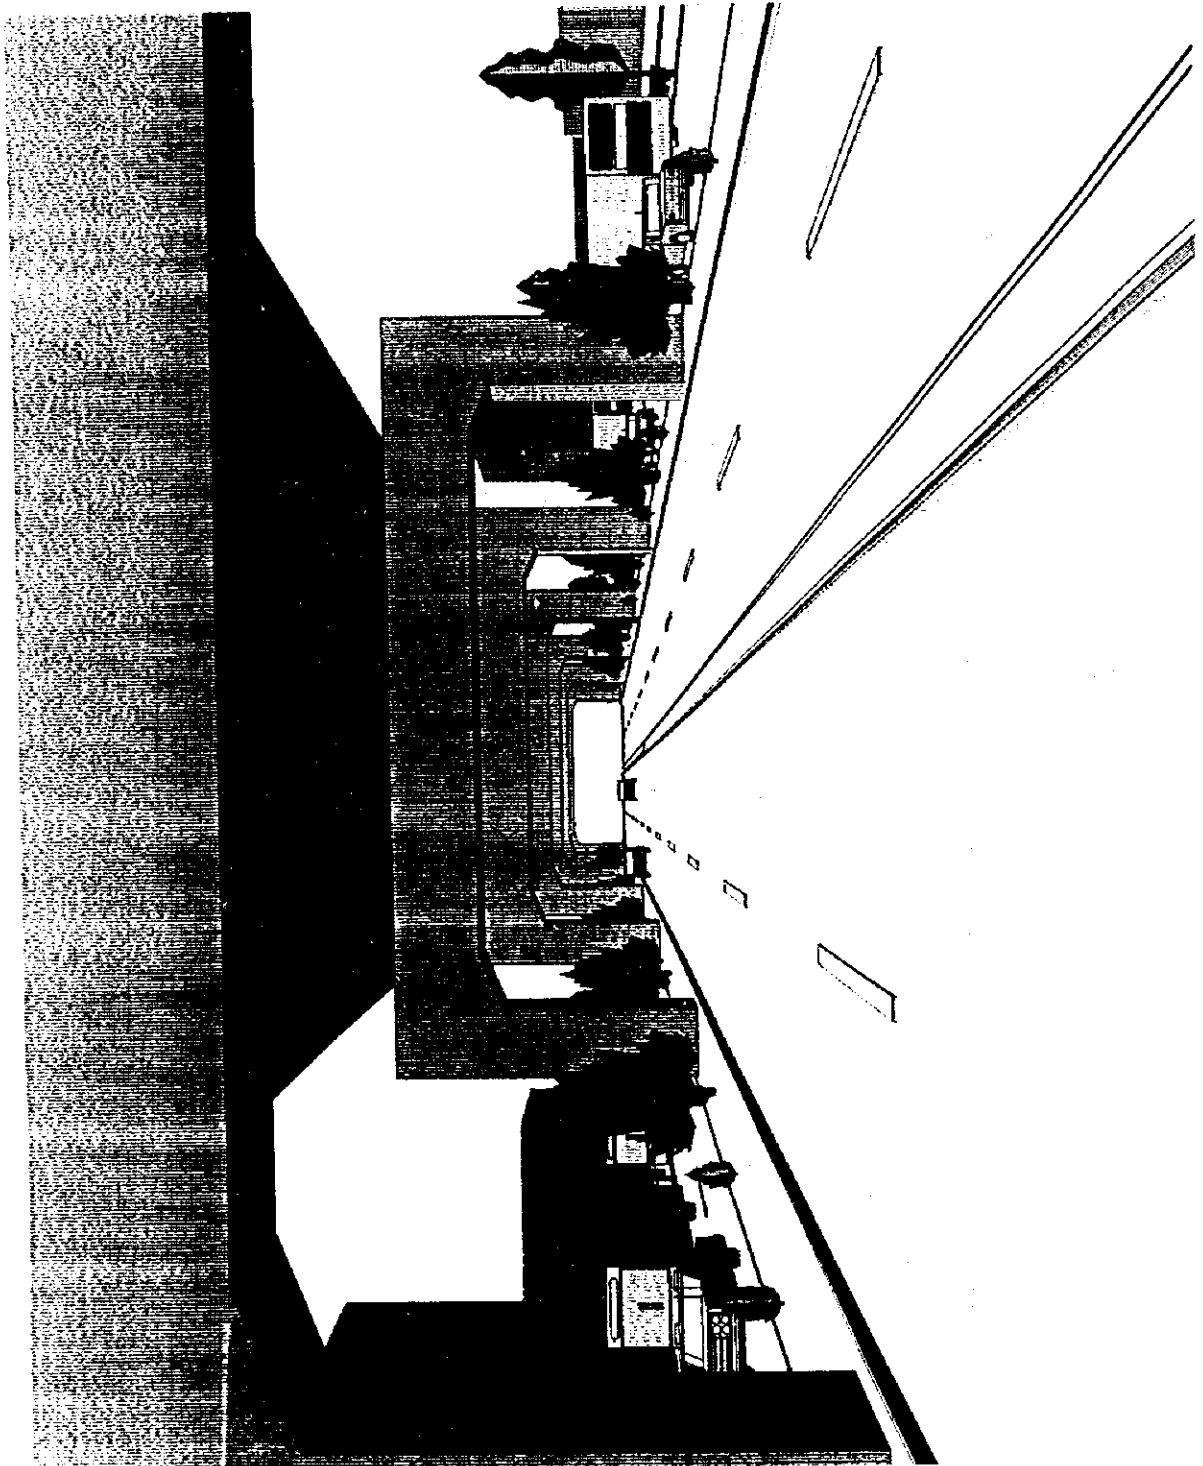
Plano tridimensional de la Alternativa -A (1)
